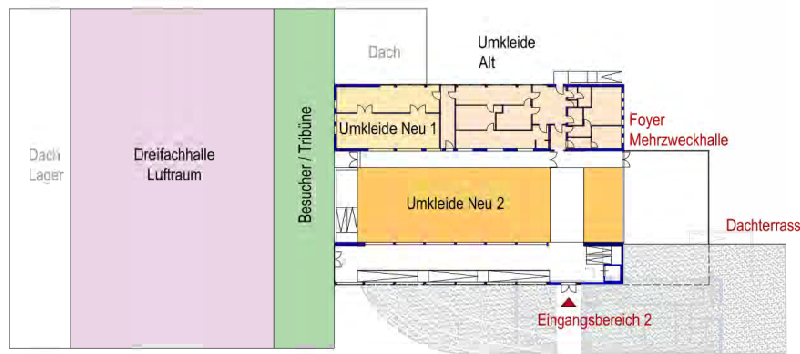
Variante 2 mit Option einer Dreifachturnhalle - Sanierung und neue Erschließung mit einer barrierefreien Rampenlösung
